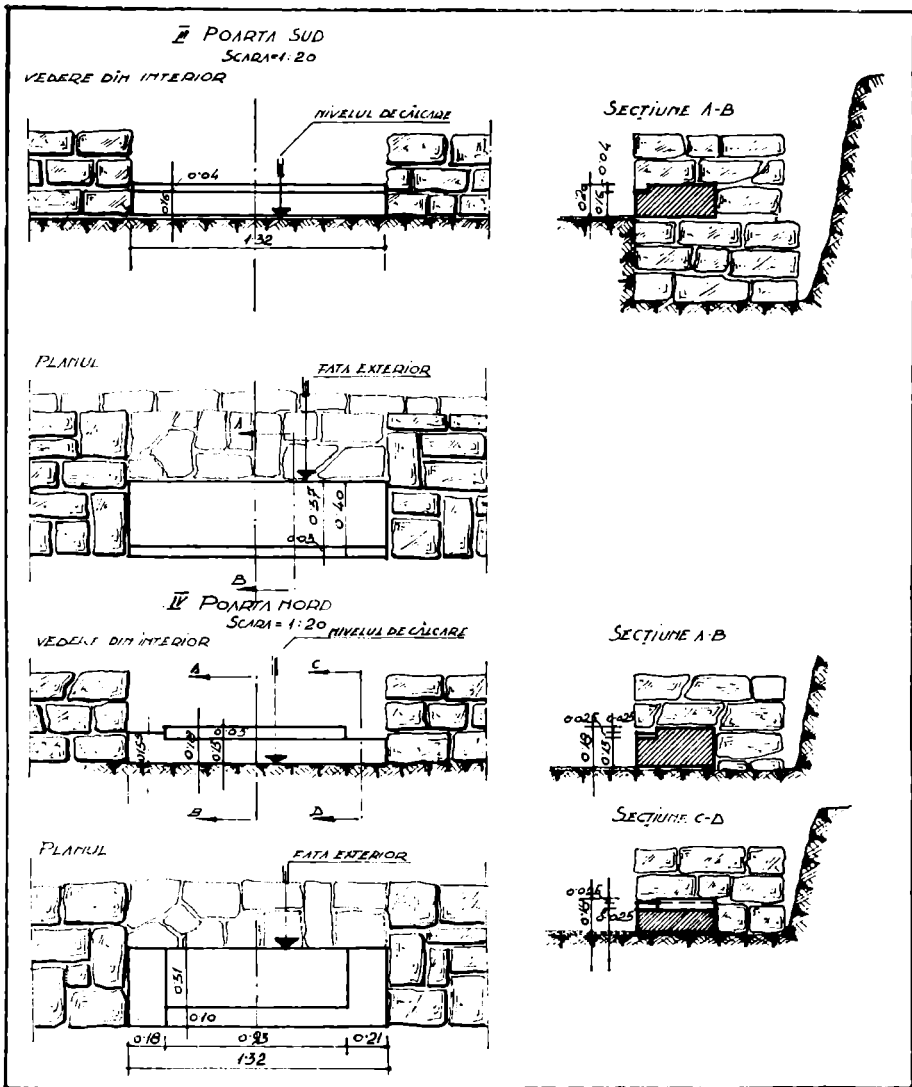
PLANUL DE DETALIU AL PORTILOR SECUNDARE,
